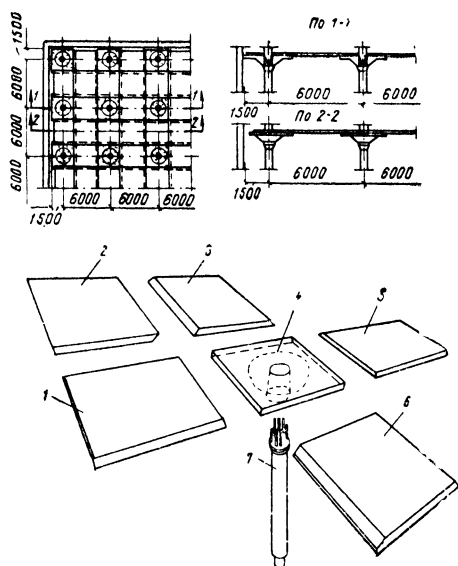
Монтажный план, сечения и элементы сборного безбалочного перекрытия с гладкими потолками:
